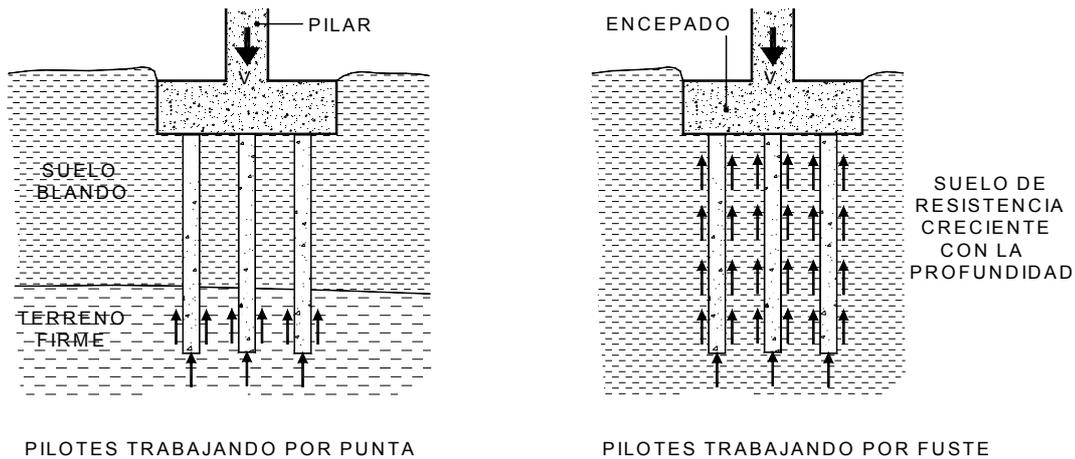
Esquema de cimentaciones profundas (pilotajes)
